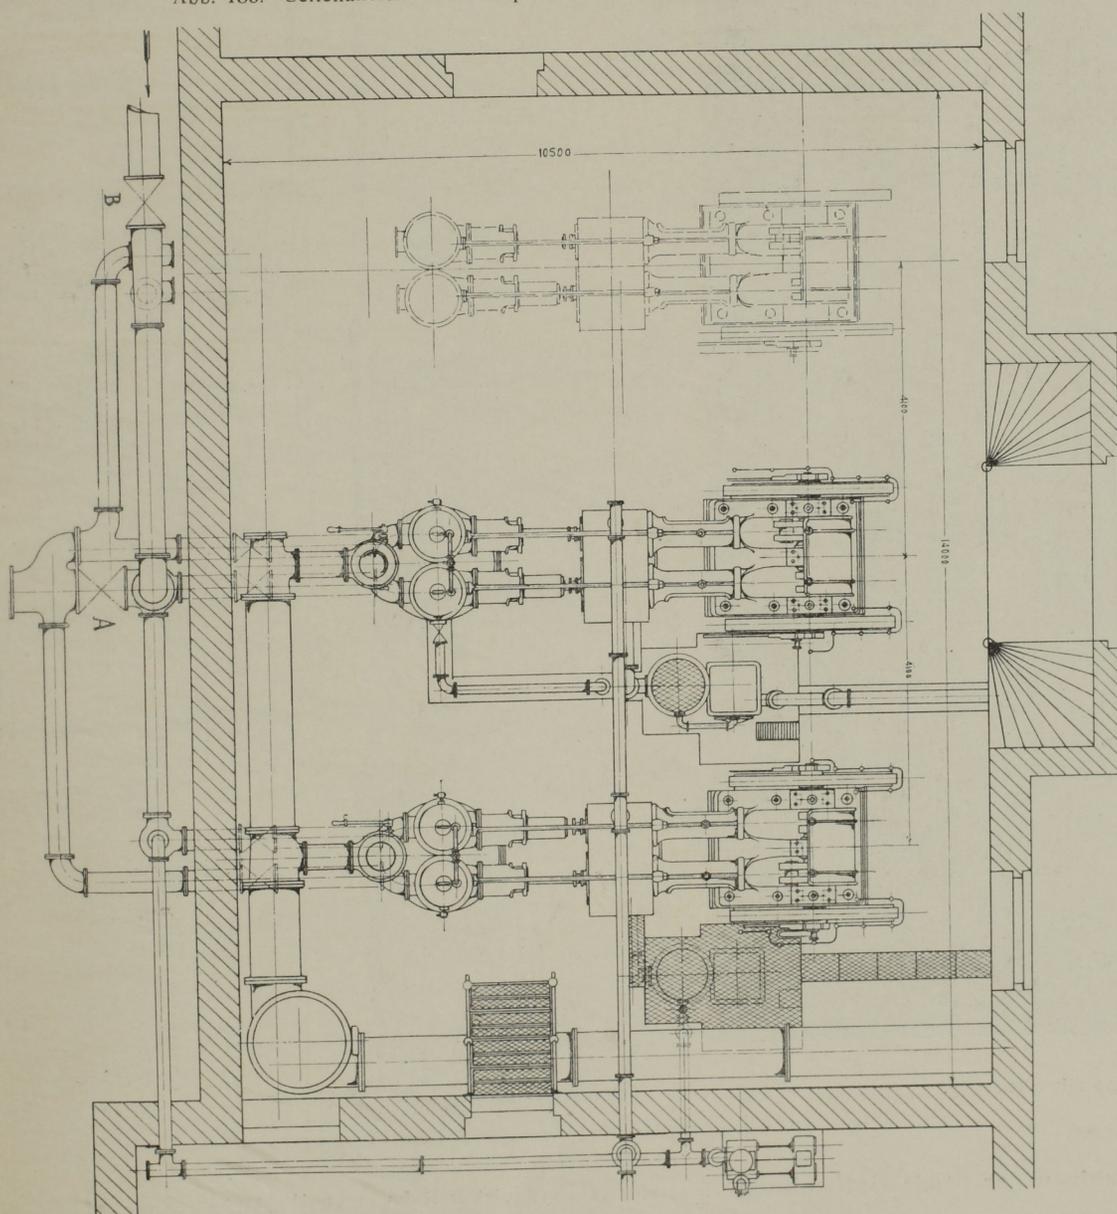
Grundriss der Pumpenanlage. Masst. 1:100.
